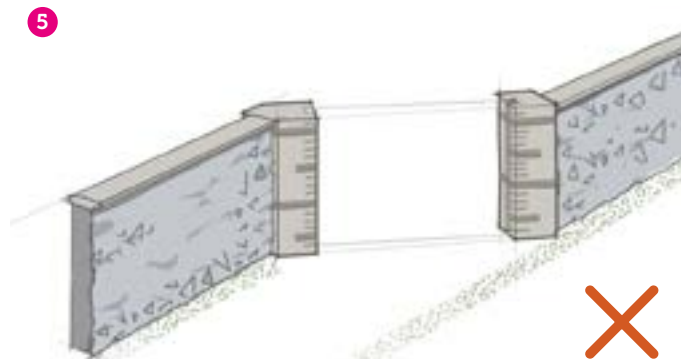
Principe aansluiting dijk op muur zuidzijde Kasteellaan.
